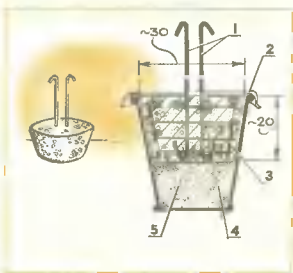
Опорная подушка: 1 — выпуск арматуры, 2 — пленка, 3 — арматура, 4 — бетон, 5 — песок.
